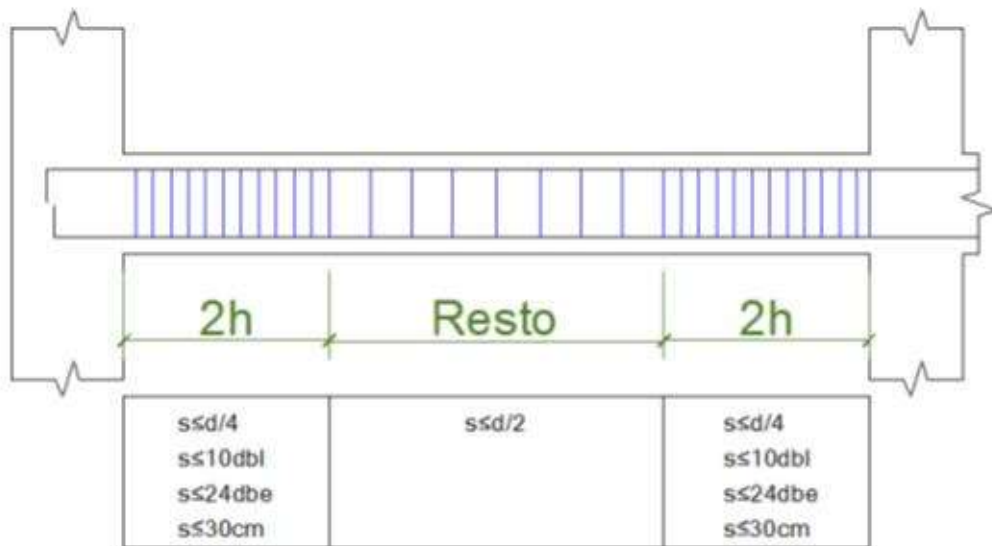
Distribución mínima de estribos en vigas para un sistema de muros estructurales o dual tipo I.
